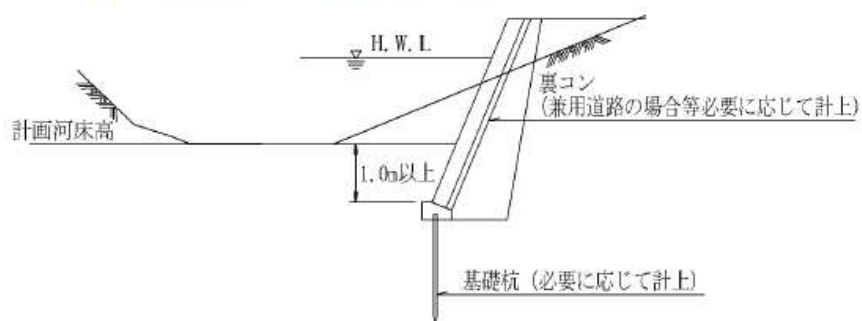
護岸基礎の根入れ(土砂礫の場合)
